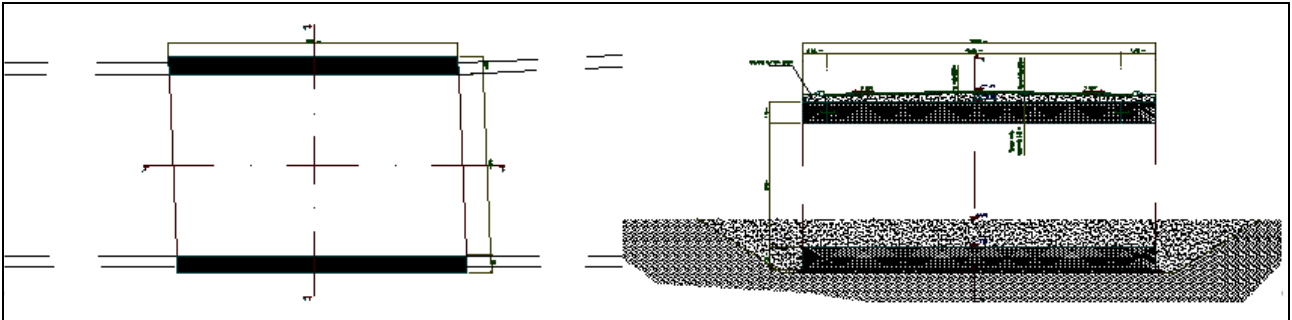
Pianta e Sezione longitudinale A-A del Sottovia Filo Longastrino
